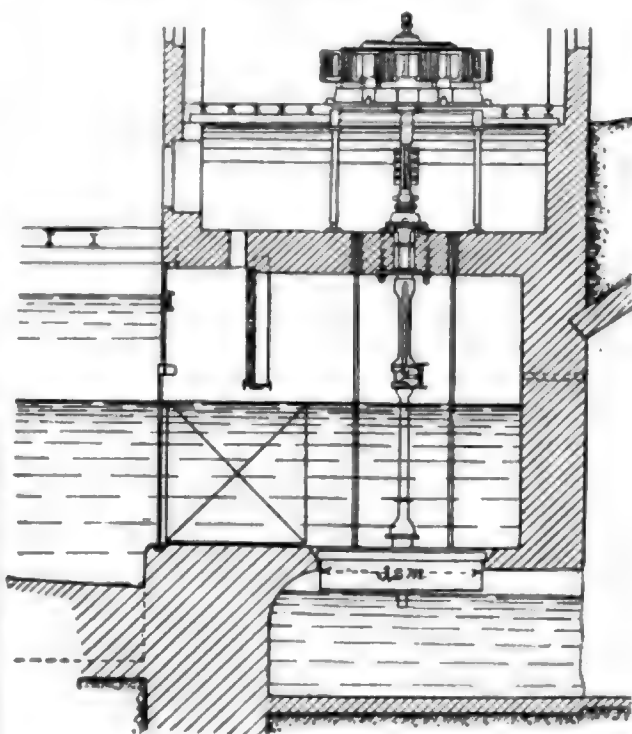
Turbine mit Dynamo im Maschinenhaus.
